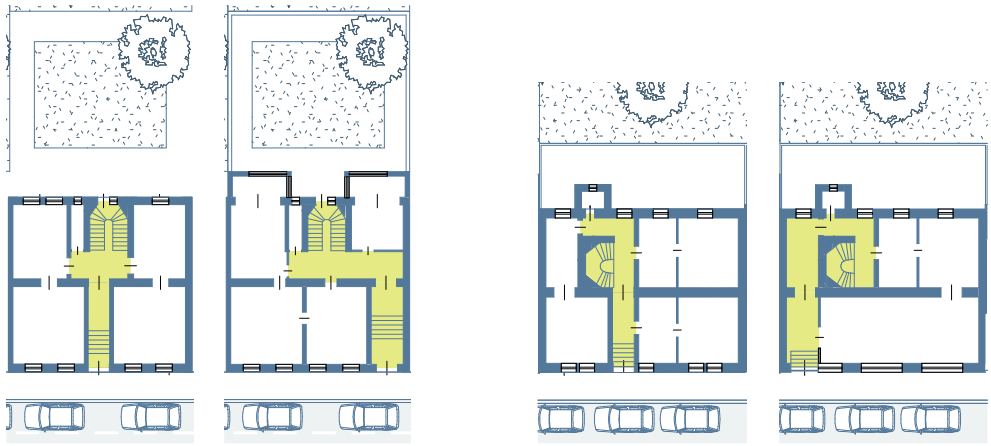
Grundriss von zwei Gründerzeithäusern mit nachträglicher Veränderung des Erschließungssystems
